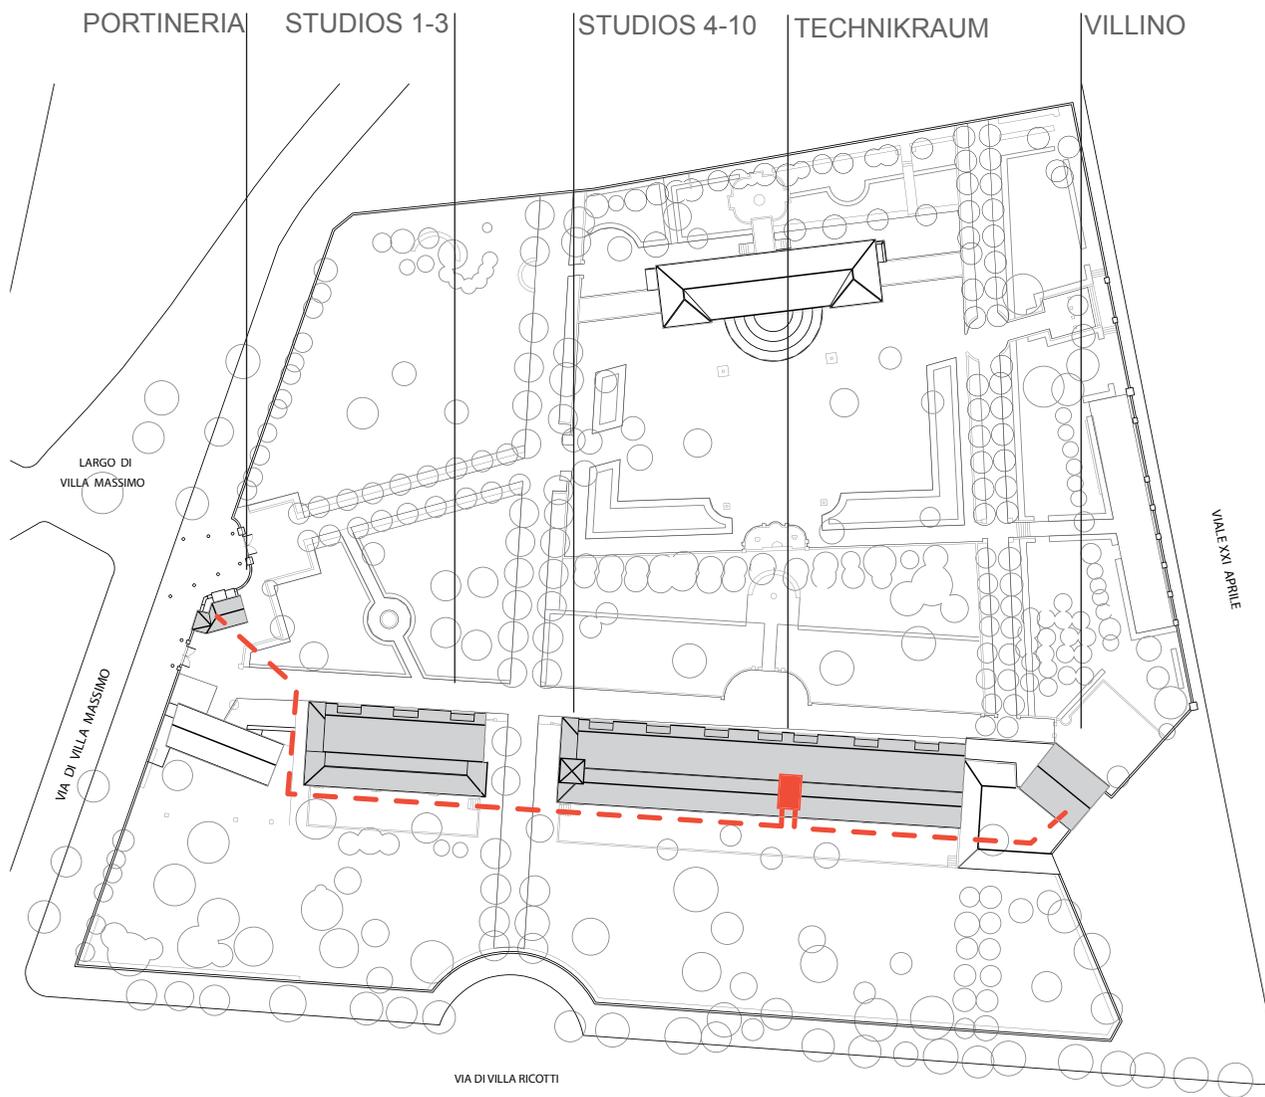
Lageplan Haustechnikraum Studios
